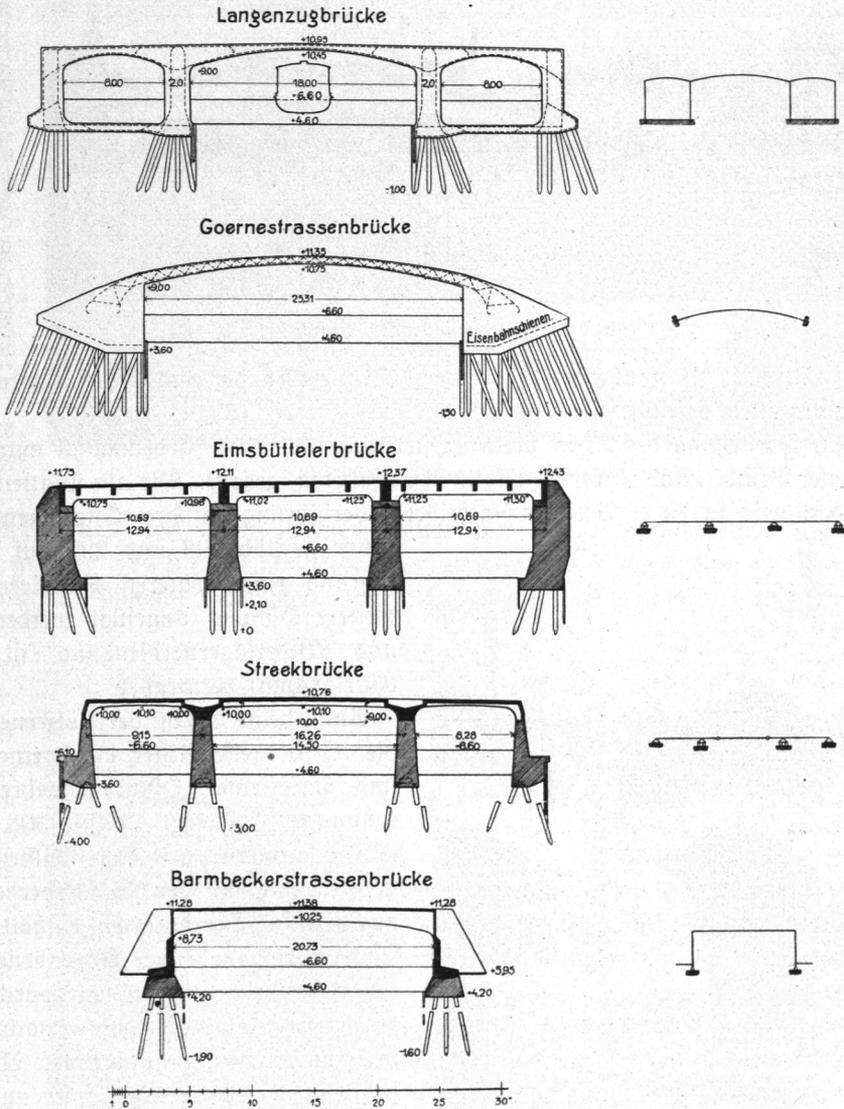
bis 303. Grundformen von Eisenbetonbrücken.
